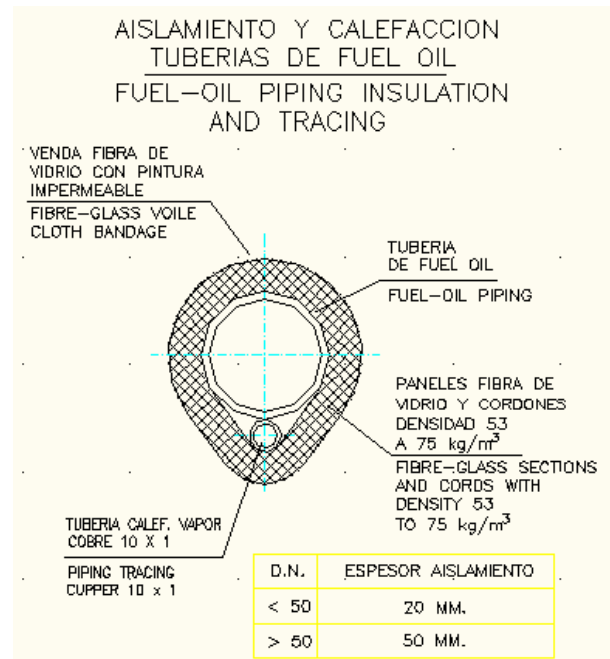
Esquema aislamiento y calefacción tuberías fuel-oil.
